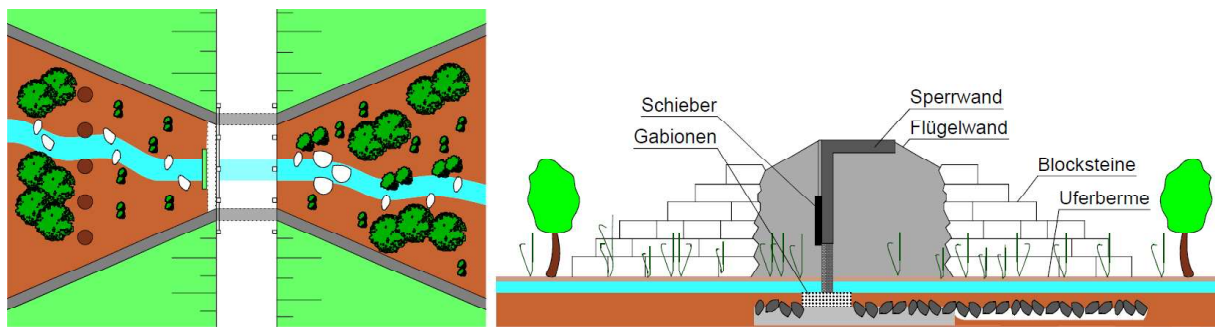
Grundriss und Längsschnitt eines Damms in offener Bauweise
